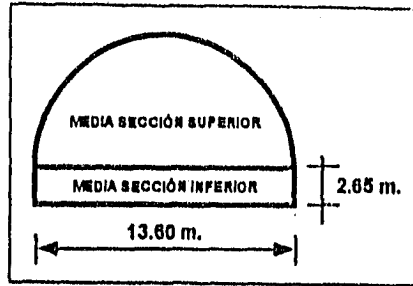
Sección Transversal dividida en media sección circular y media sección inferior.
